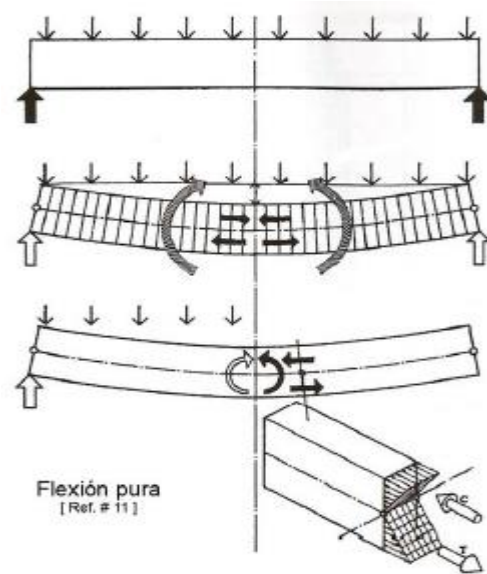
Comportamiento flexionante en vigas de concreto reforzado. Fuente: Diseño de Estructuras de Concreto. Nilson (2001).
